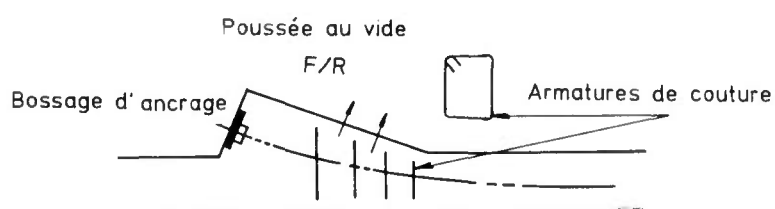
Reprise des efforts de poussée au vide au droit d'un ancrage.
